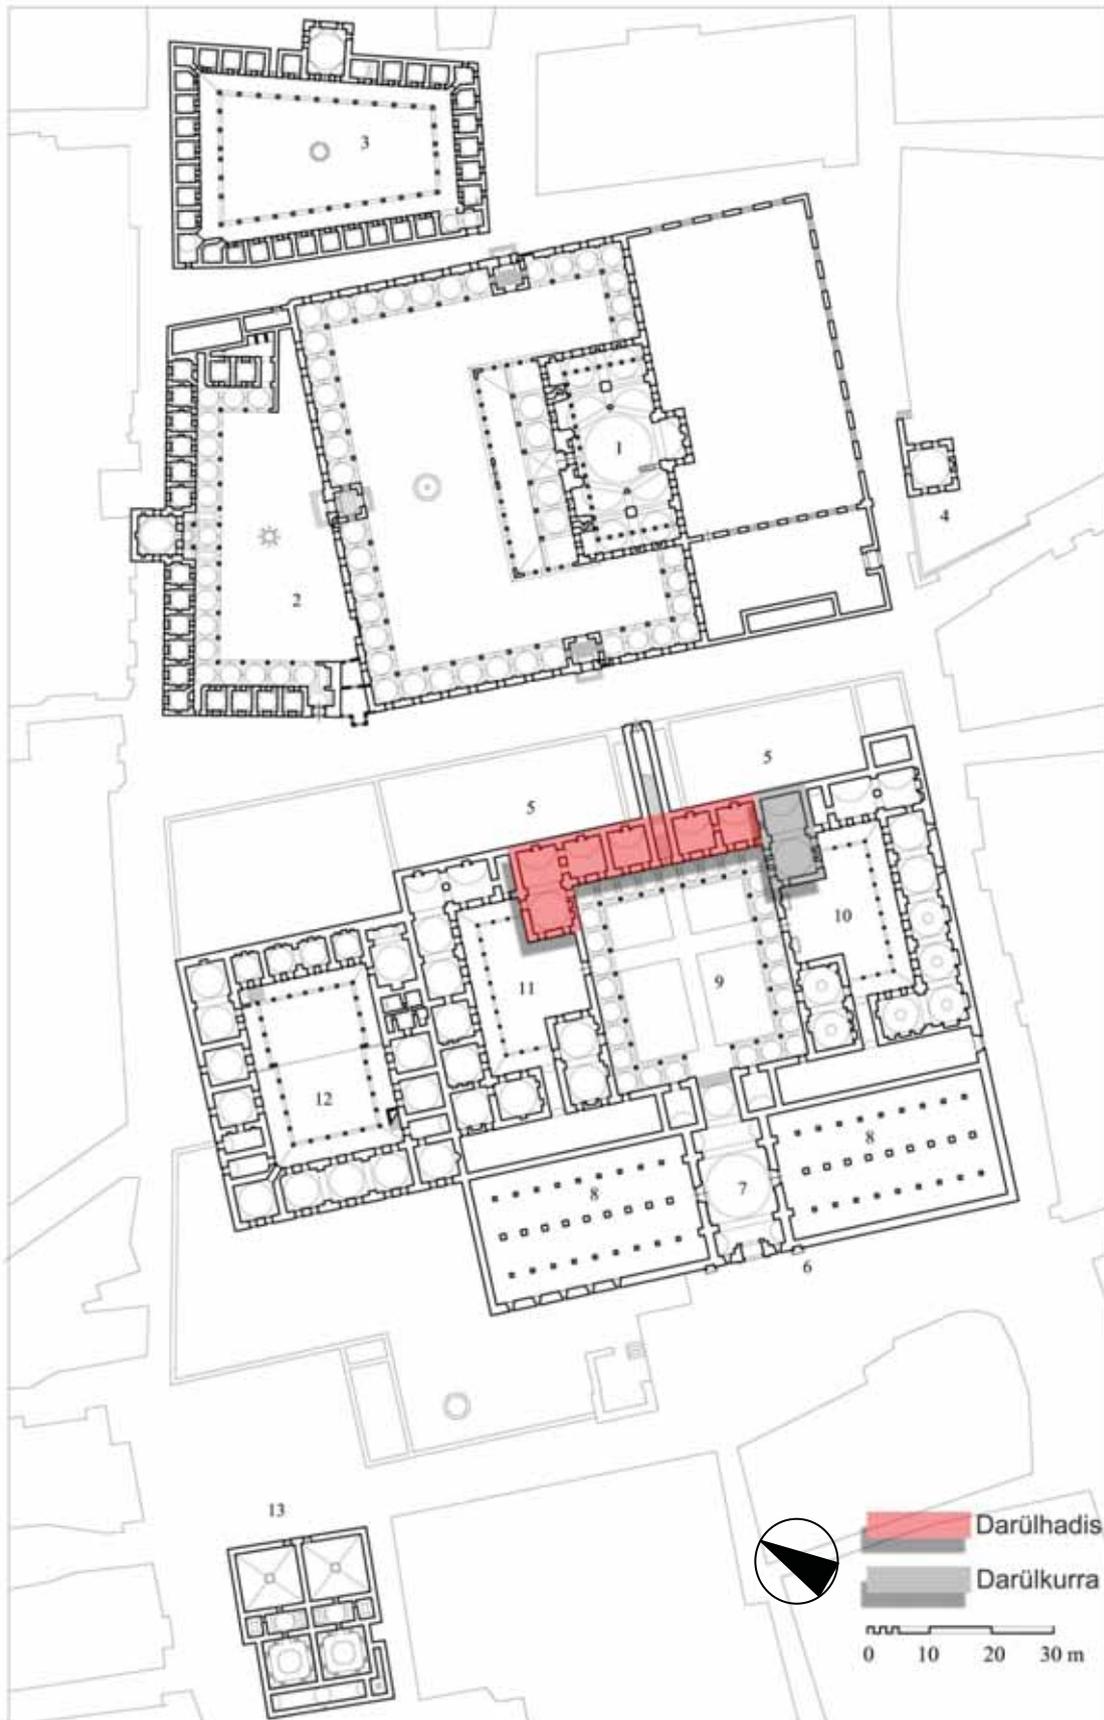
Grundriss und Lageplan der theologischen Hochschule
